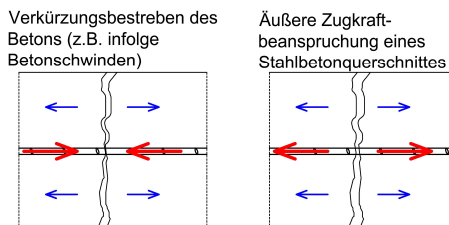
Resultierende Beton- und Stahlkräfte infolge eines Verformungsbestrebens durch Schwinden (links) sowie infolge einer äußeren Zugkraftbeanspruchung (rechts)
